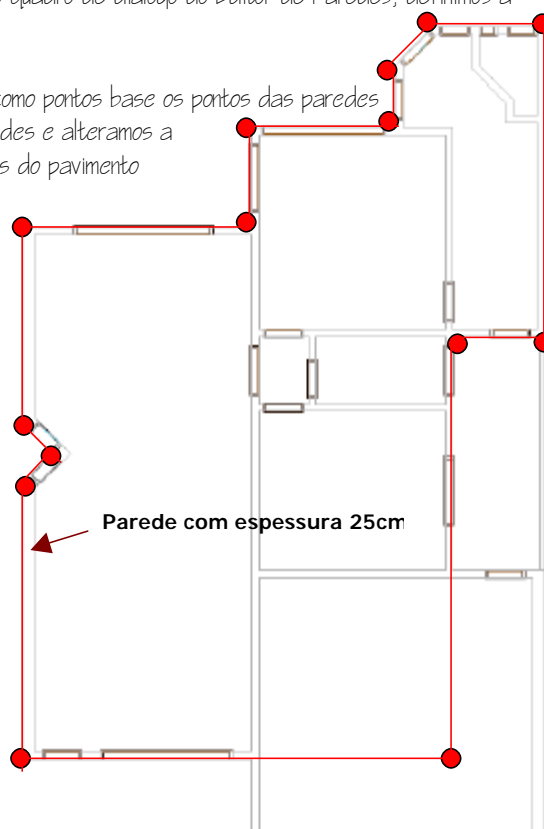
Esquema dos pontos para desenho das paredes externas do segundo pavimento. Note que o lado da parede será sempre o interno.
